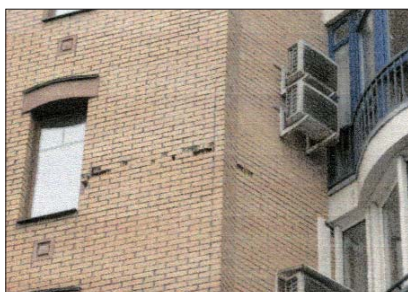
б Вертикальные трещины на углу стен и разрушение кладки в уровне перекрытия
